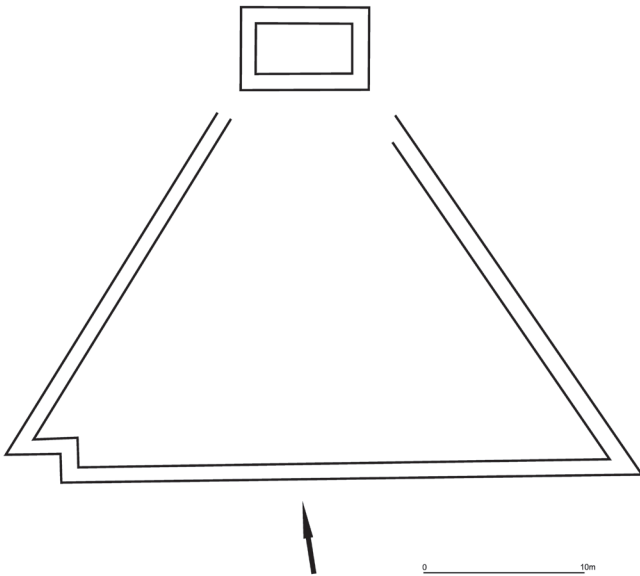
Croquis de planta de la fortificación de Valle Quebrado (El Madroño).
